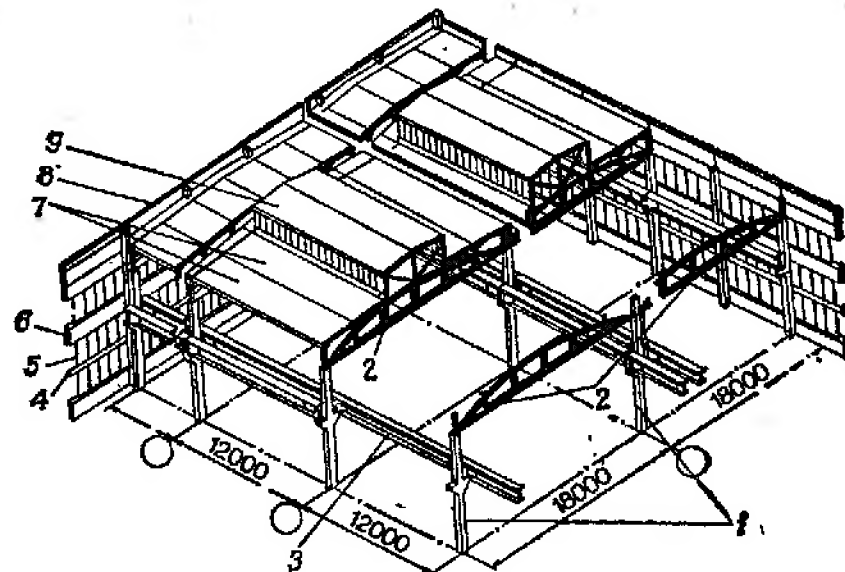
Схема каркаса одноэтажного промышленного здания:
